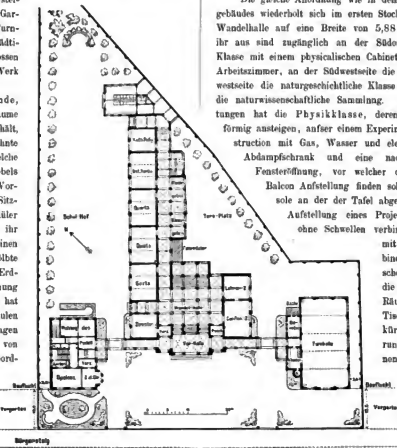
Lageplan mit Erdgeschoßgrundriss.
